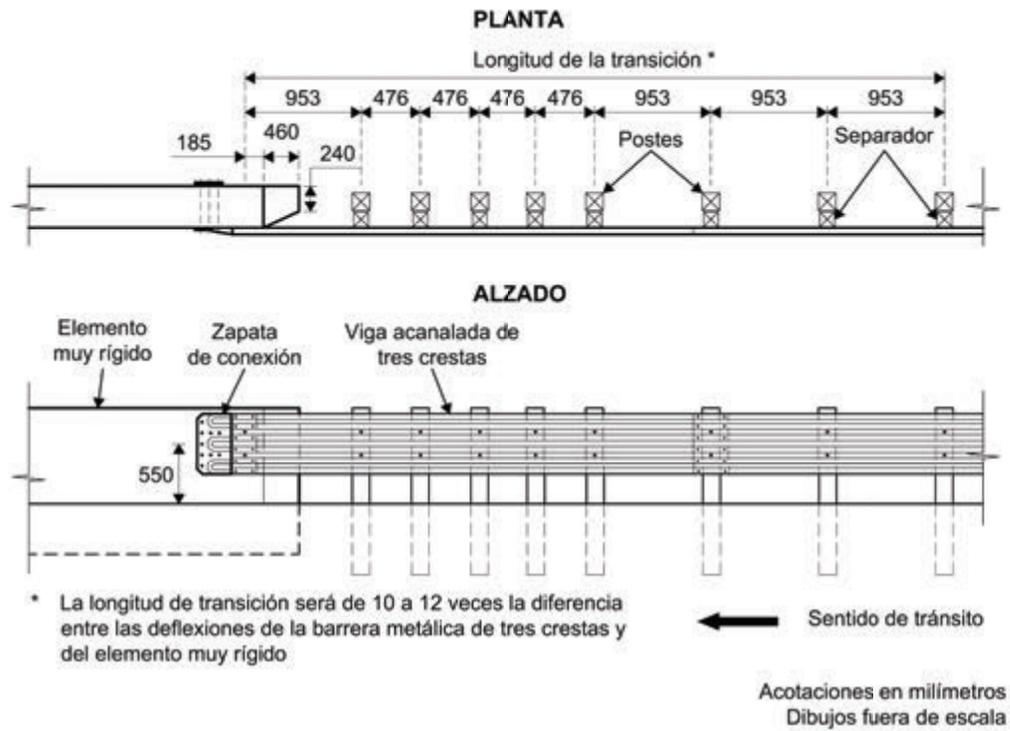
Transición de barrera metálica de tres crestas a muro vertical recto
